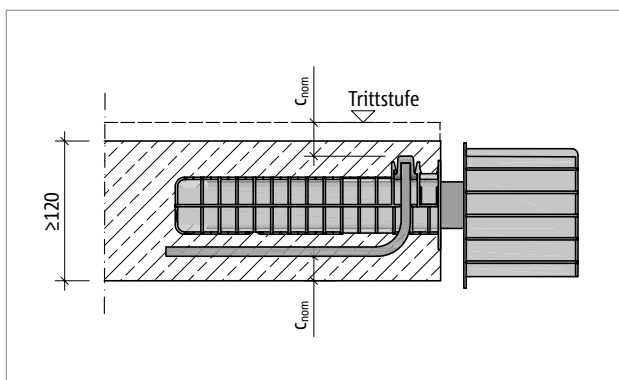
Tronsole® Q: Einbau bei Plattendicke $h = 120$ mm erfordert die Einbeziehung des Betons der Trittstufe zur Ermöglichung der Betondeckung c_{nom}
